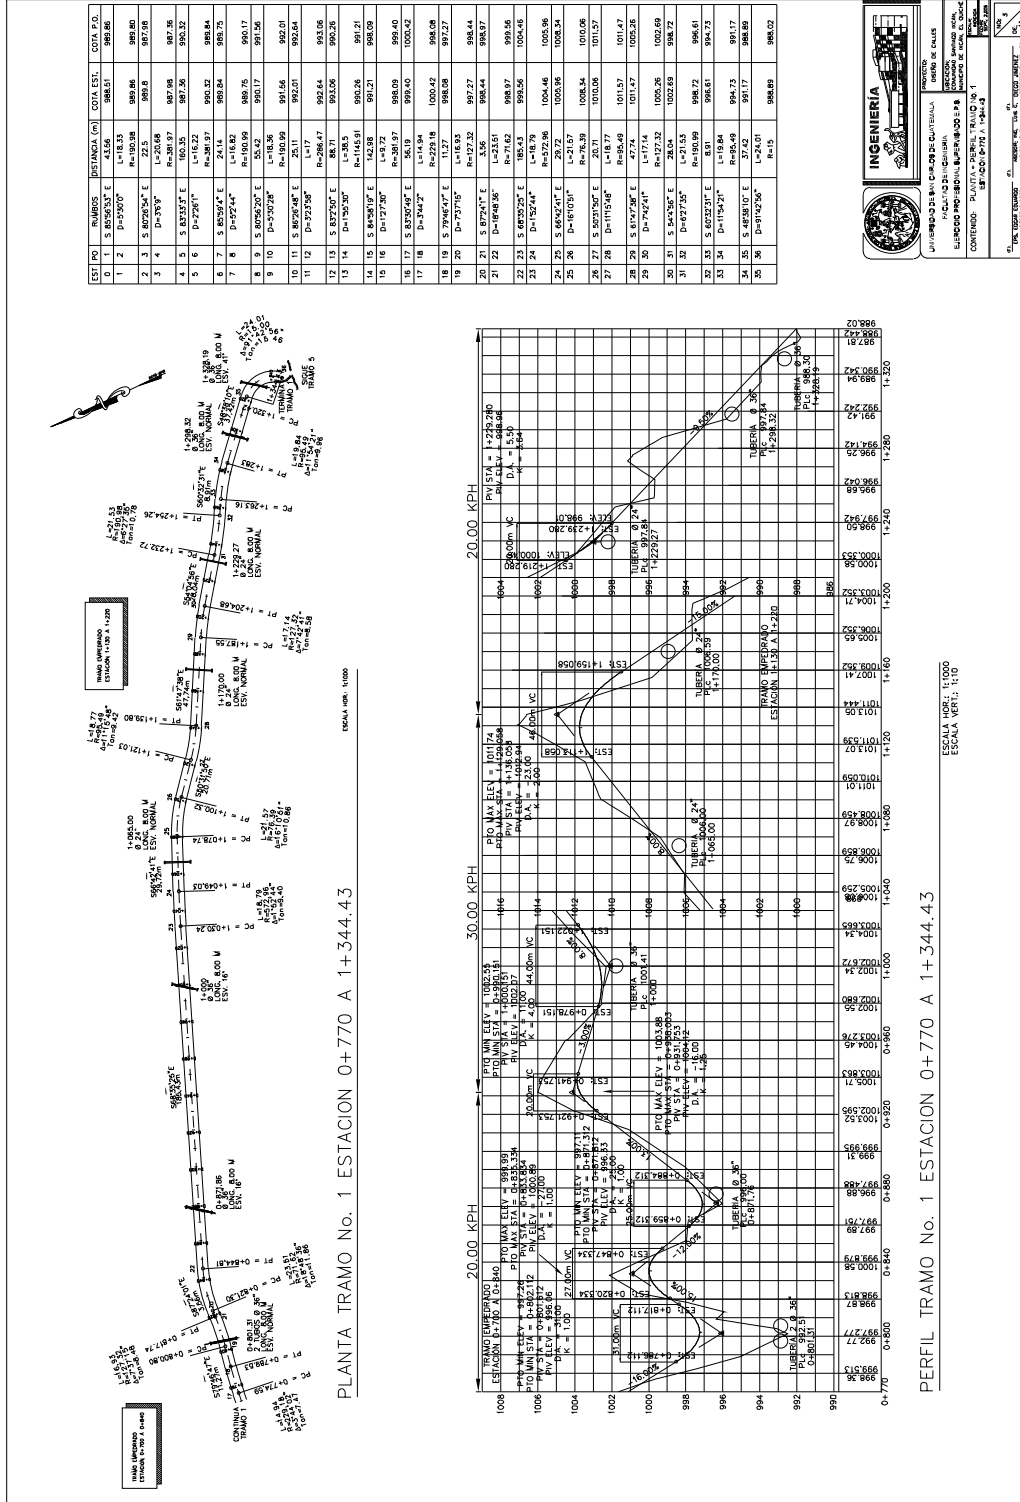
Planta-perfil tramo 1 estación 0+770 - 1+344.44.
